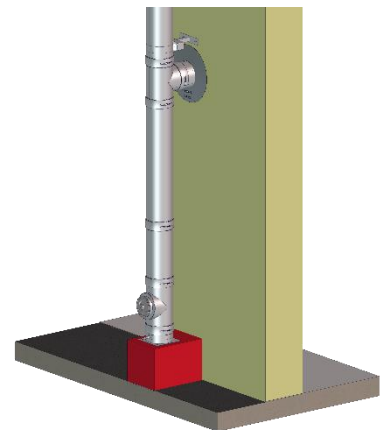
Aufbau mit Grundplatte für Sockelmontage
